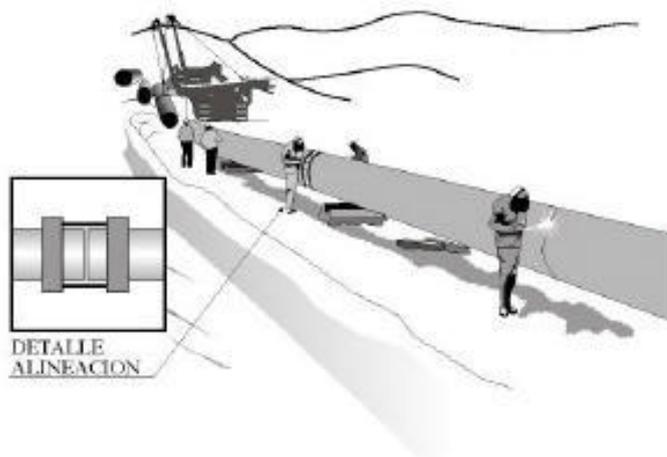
Alineación y Soldado de la Cañería
